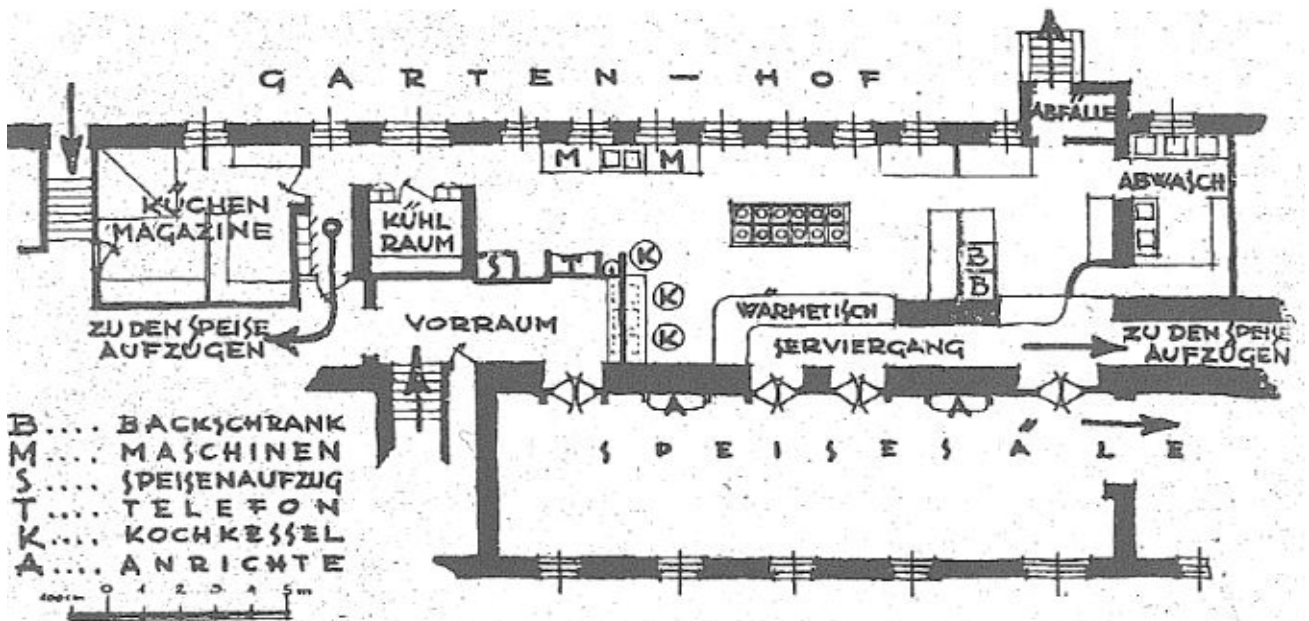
Erdgeschoß Einküchenhaus, M 1:200
